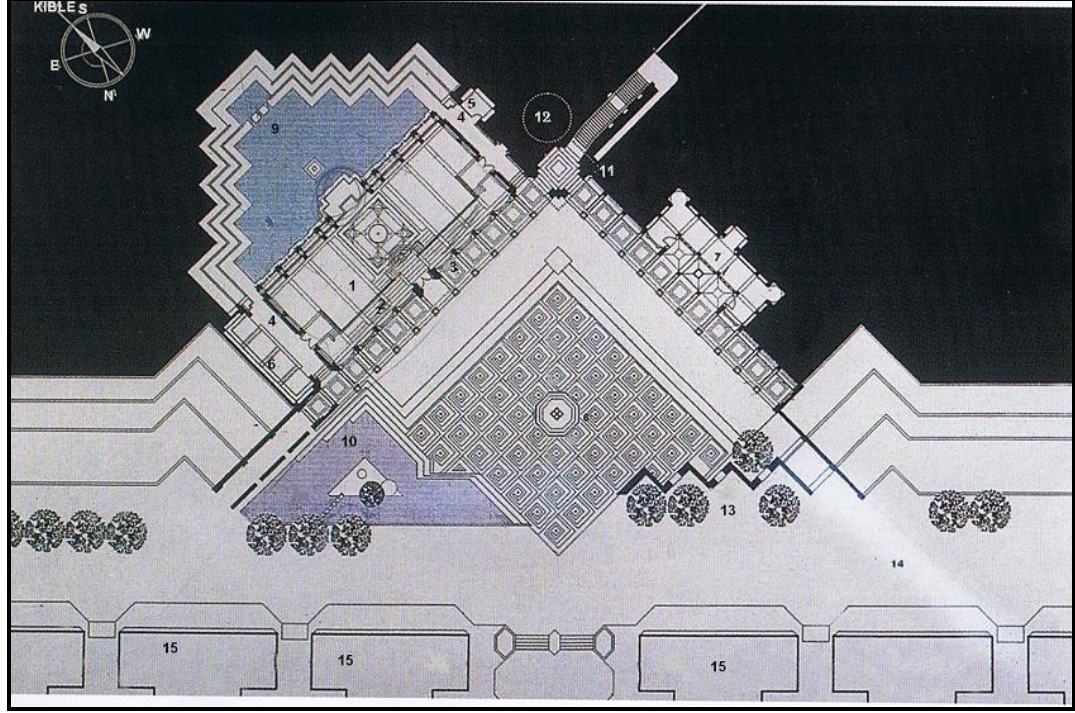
TBMM Kompleksi Vaziyet Planı
